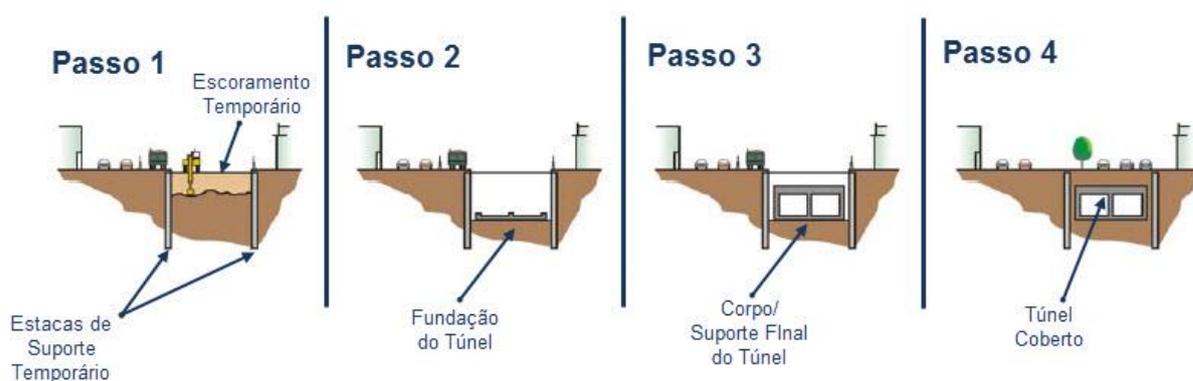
Sequência da construção de baixo para cima a céu aberto de (adaptado de FHWA, 2009).
